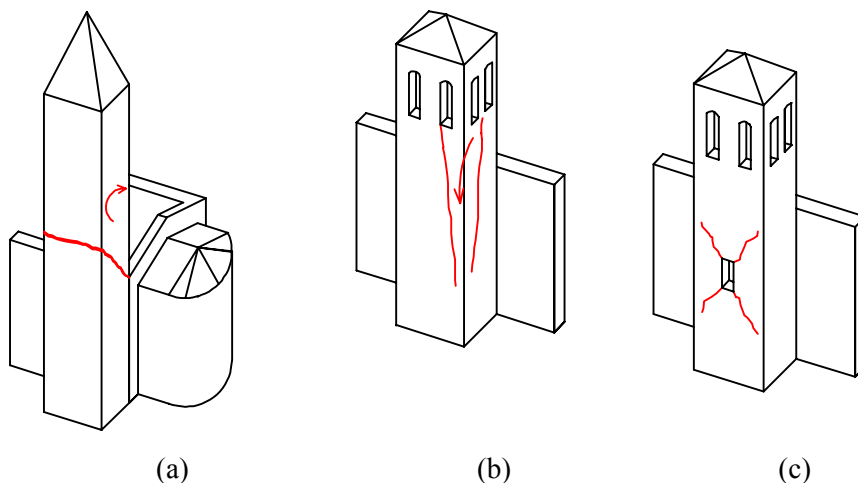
Danos na torre sineira: (a) flexão com rotação na zona de alteração brusca de rigidez; (b) rotação para o exterior de um canto; (c) rotura por corte na zona inferior junto às aberturas.
